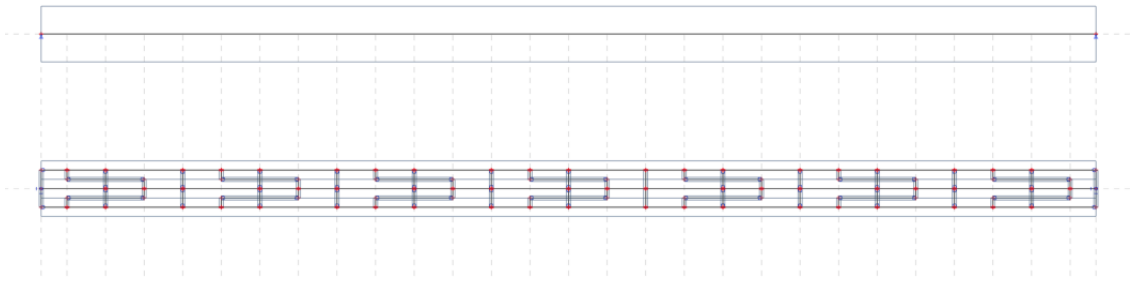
Parallèle entre poutre monolithique et poutre assemblées par bifaces sur Scia Engineer.
